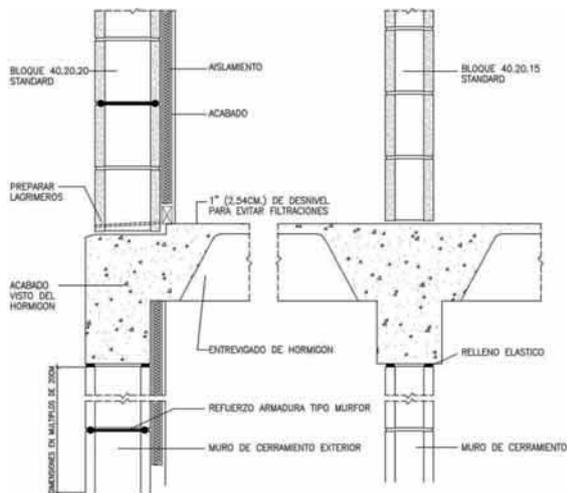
Sección de encuentros de muros de 1 hoja de cerramiento y partición con el forjado. Estructura vista y viga de canto.
